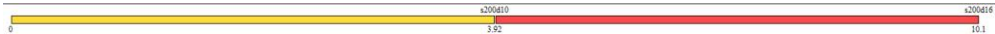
Поперечна арматура нижнього поясу
